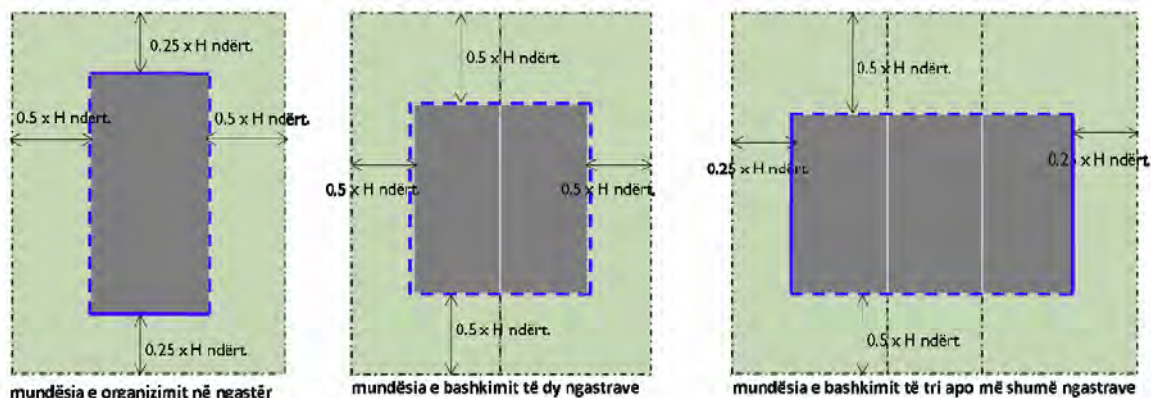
Madhësitë e ngastrave dhe distancat e shfrytëzimit të ngastrave
